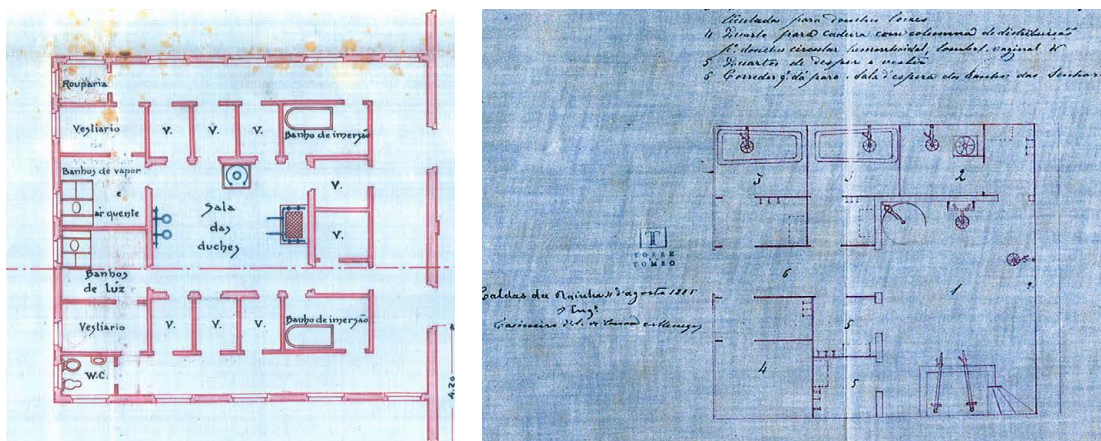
a) Caldas de Vizela, Planta Rés-do-Chão; b) Caldas da Rainha, Planta de Duches (Mangorrinha e Pinto, 2009)
